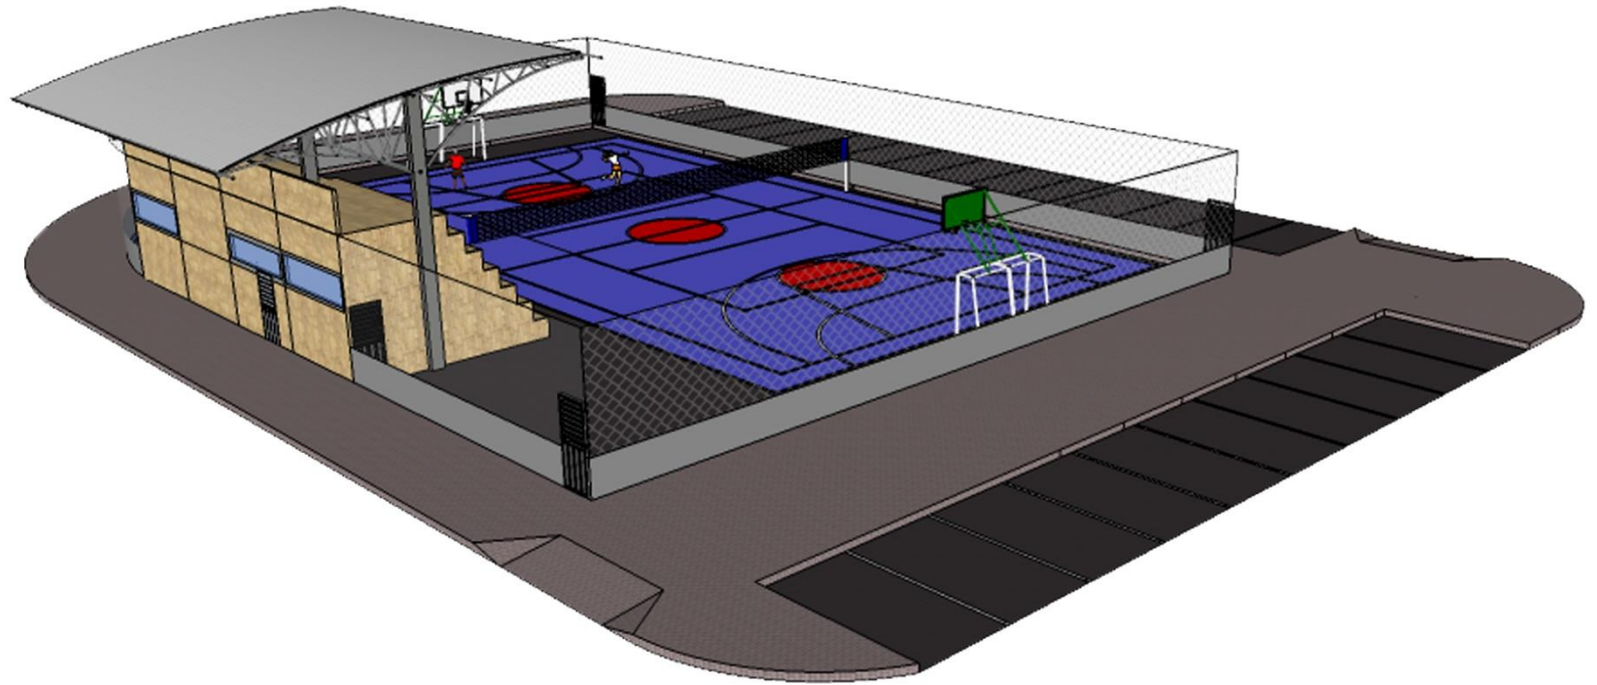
Planta arquitectónica de cancha de uso múltiple y cancha de tenis
